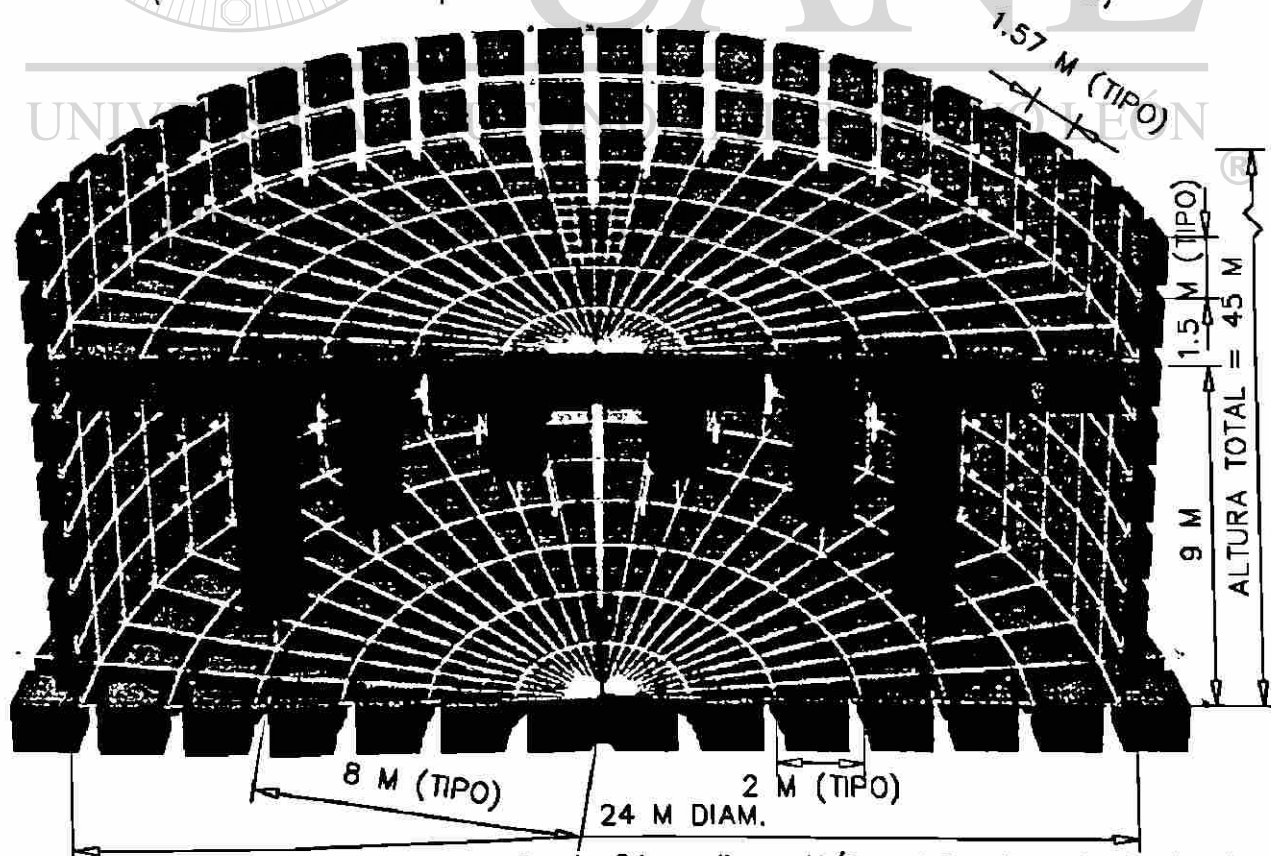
Geometría de medio silo de 24 m diam., $H/D = 1.5$ y losa de fondo plana.
